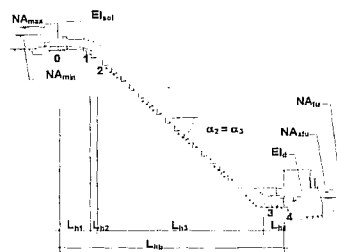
Perfil esquemático de conduto forçado com três trechos.
